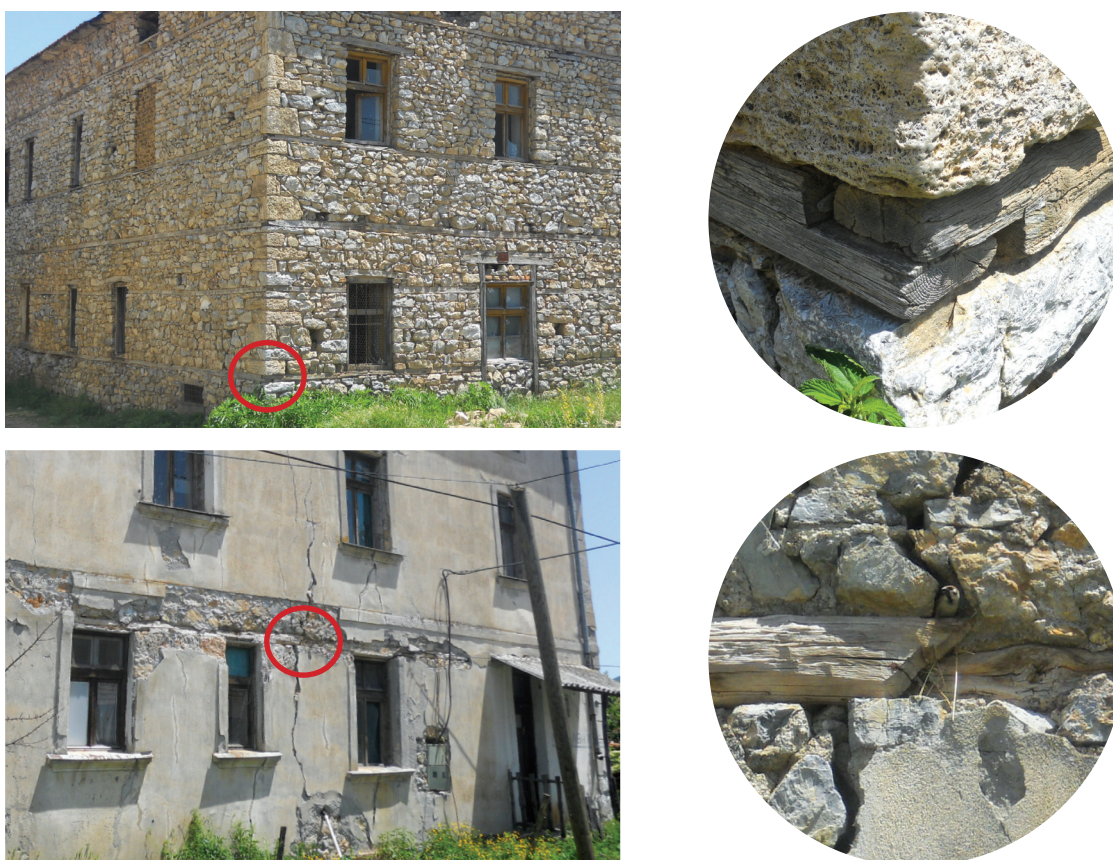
Relâchement de l'assemblage d'angle (a,b) et du raccordement longitudinal entre les tasseaux (c,d).
